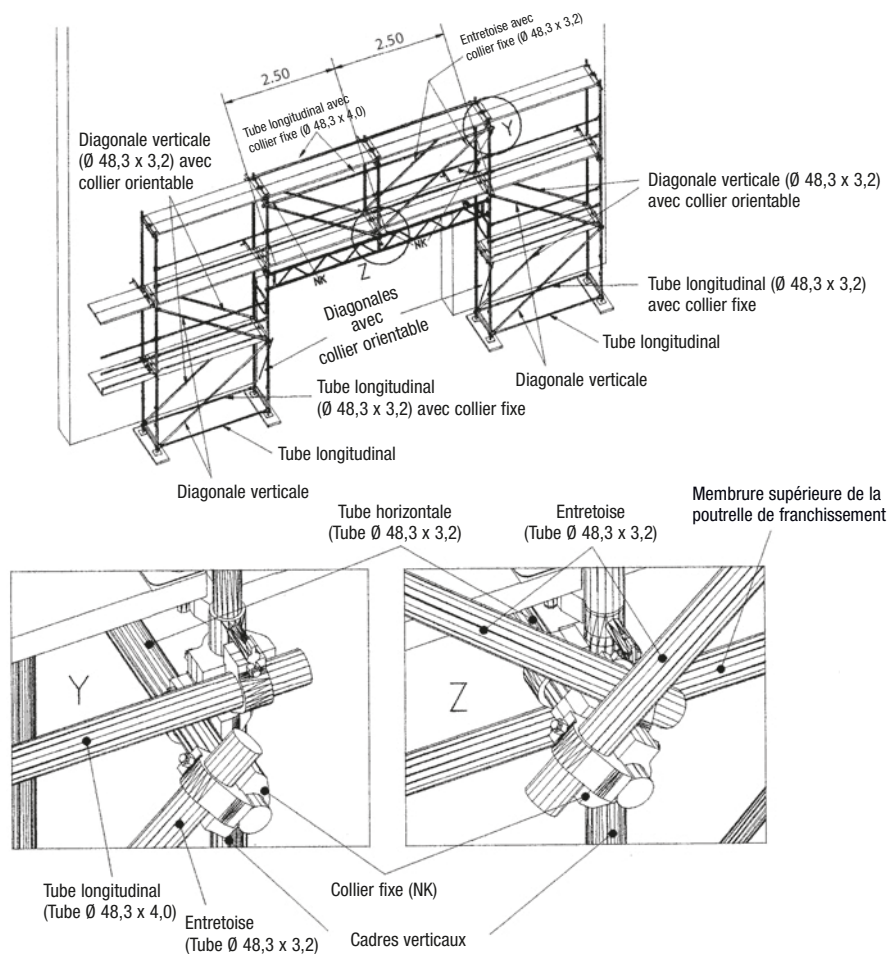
Montage avec entretoise; renforcement de la membrure supérieure par ancrage dans la façade ou par moise horizontale.
